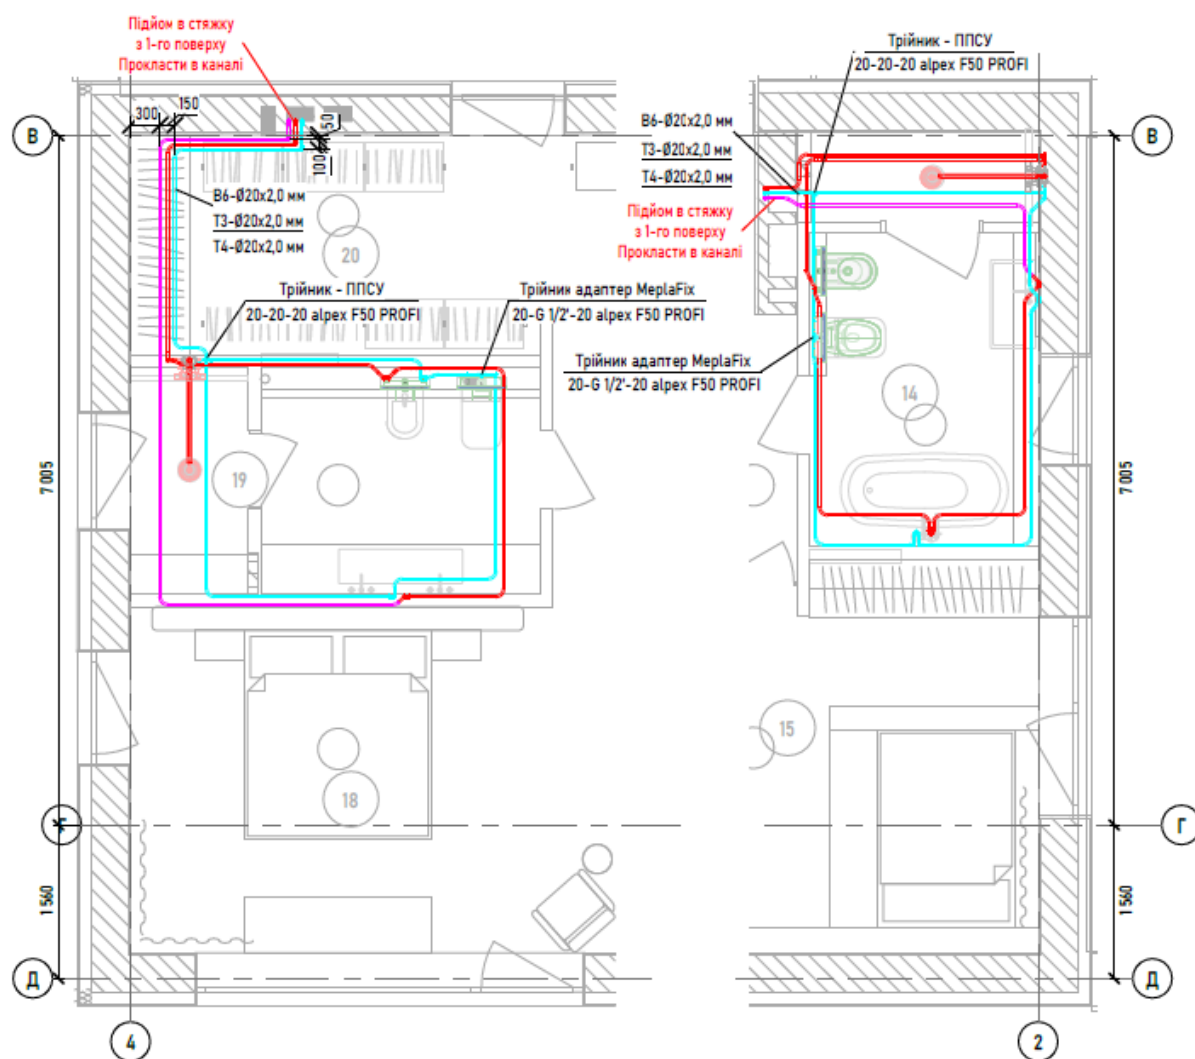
Система водопостачання. План 2-го поверху
